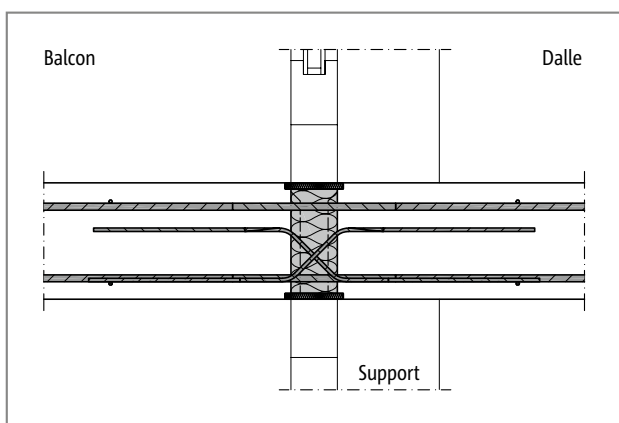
Schöck Isokorb® T Type D : Coupe de montage ; plancher plat
